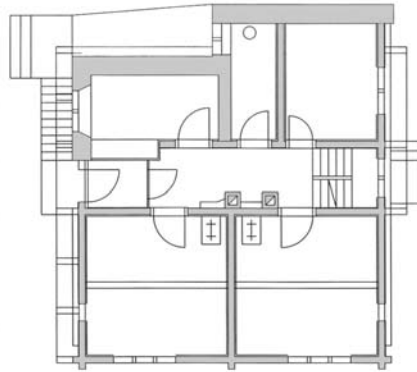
Gebäudeinventar. Lumbrin, Haus Nr. 111. Grundriss Erdgeschoss. Der Plan lässt deutlich zwei unterschiedliche Konstruktionsweisen erkennen: Zwei Strickkuben liegen vor einem Mittelkorridor, welcher diese und die teilweise noch im Mauerwerk sitzenden rückwärtigen Räume (Küche und ehemaliger Vorratsraum) erschliesst. Mst. 1:250.
